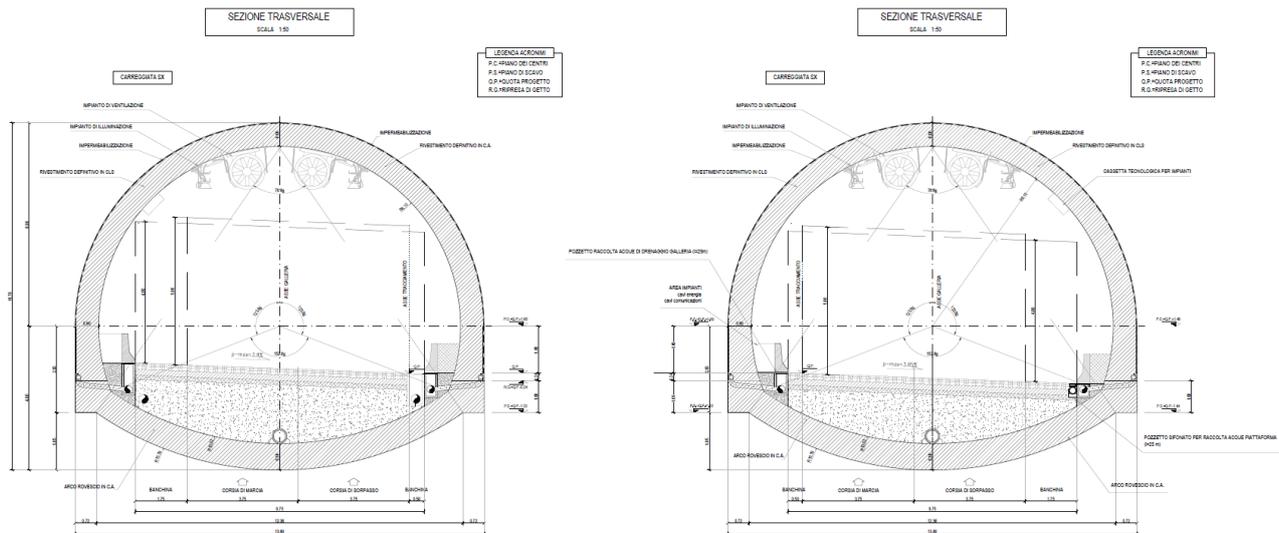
Sezione tipo corrente galleria “Le Ville”
